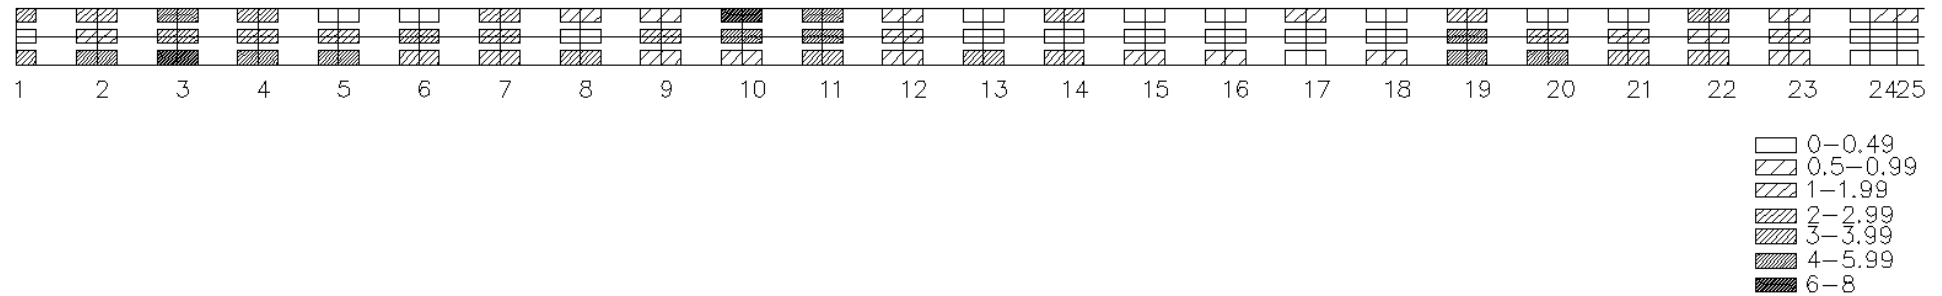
Frästiefen bei Tangenten und quadratischen Parabeln und Verfahrensplan Typ C, Grundriss, Stationen 1-25
